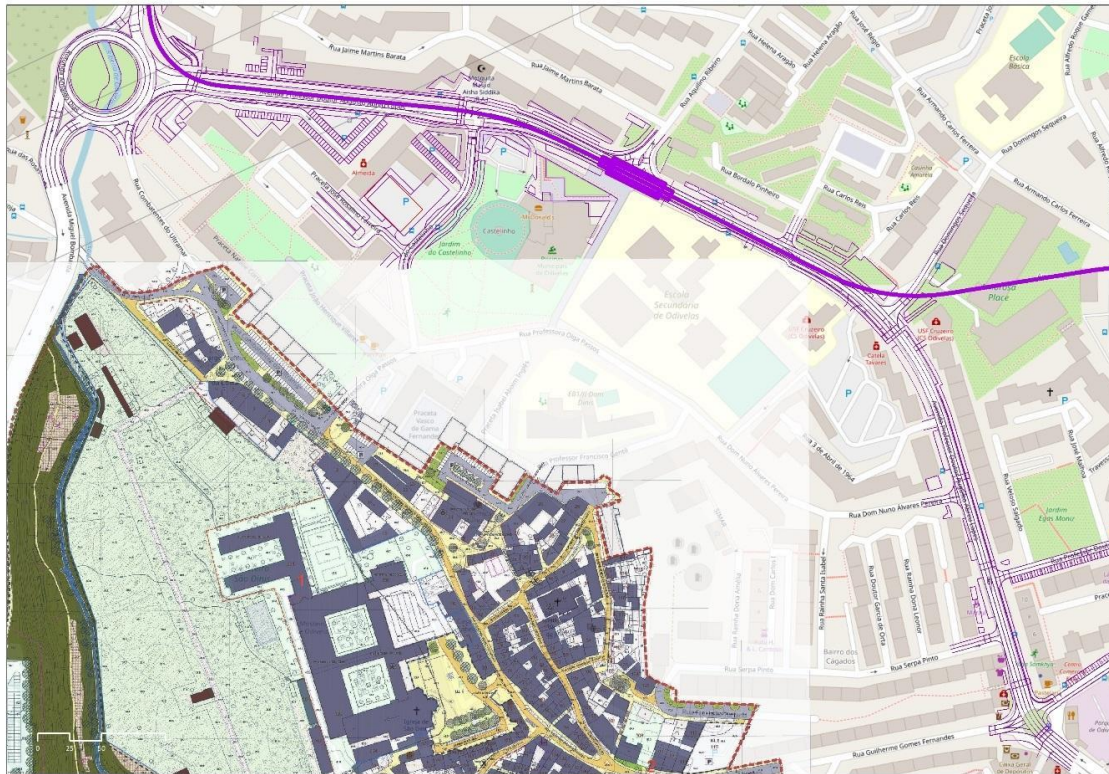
Sobreposição do traçado da Linha Violeta com o Plano de Pormenor do Centro Histórico de Odivelas
